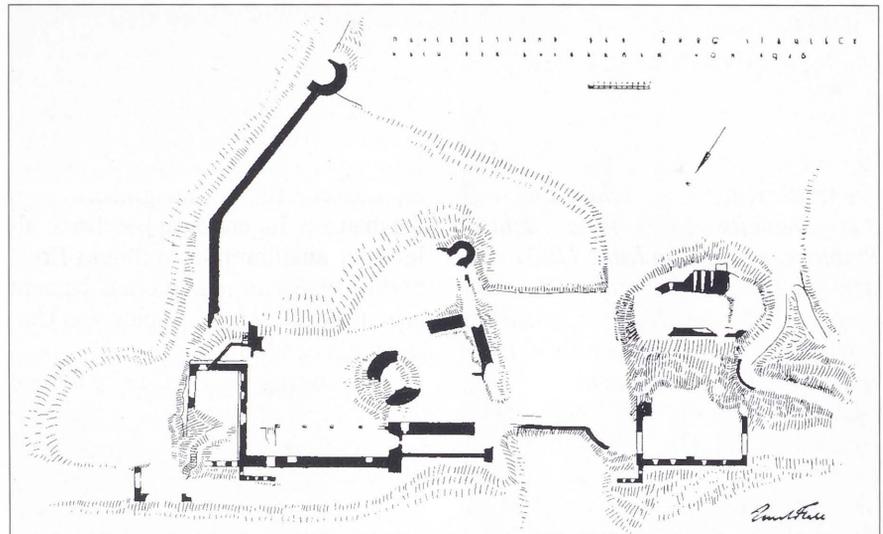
Grundrisse der Burg Stahleck vor und nach der Grabung 1926, Ernst Stahl 1926.
